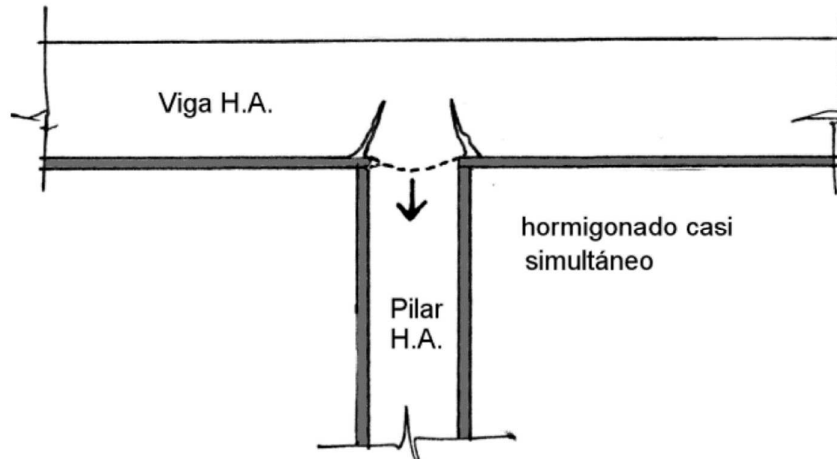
Asentamiento plástico en viga - columna(Fuente, MPE)
